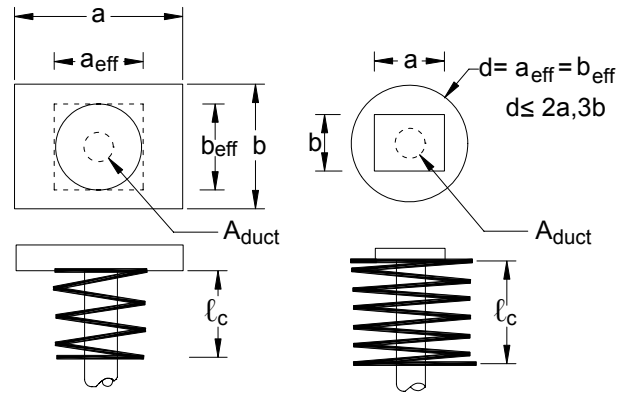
Área de apoyo efectiva
